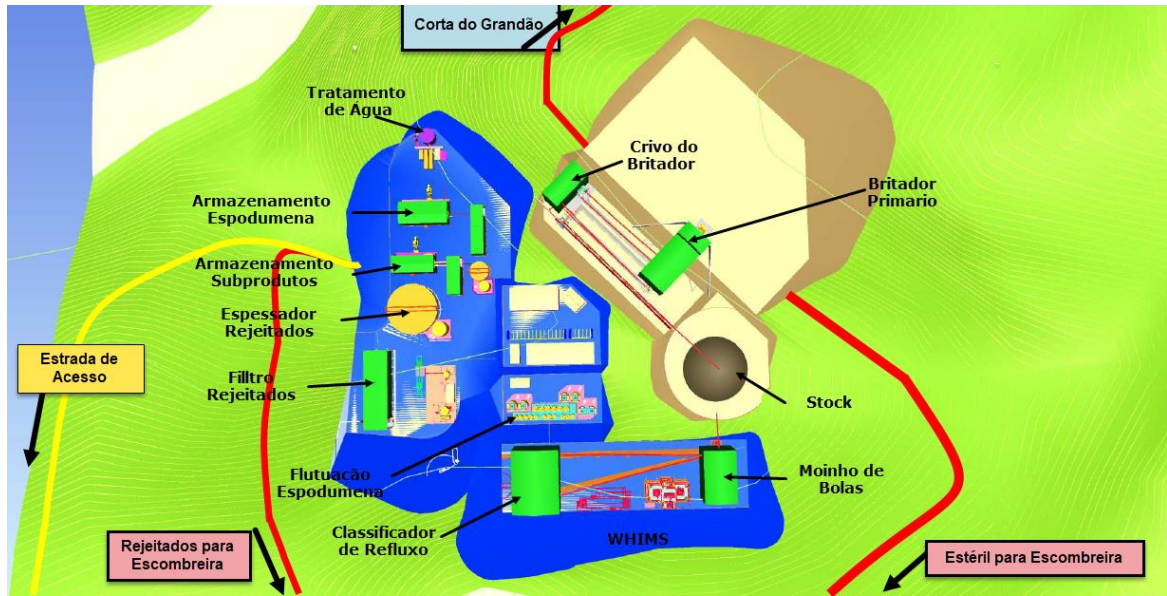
Planta esquemática da Lavaria com os Pontos de Acesso.
